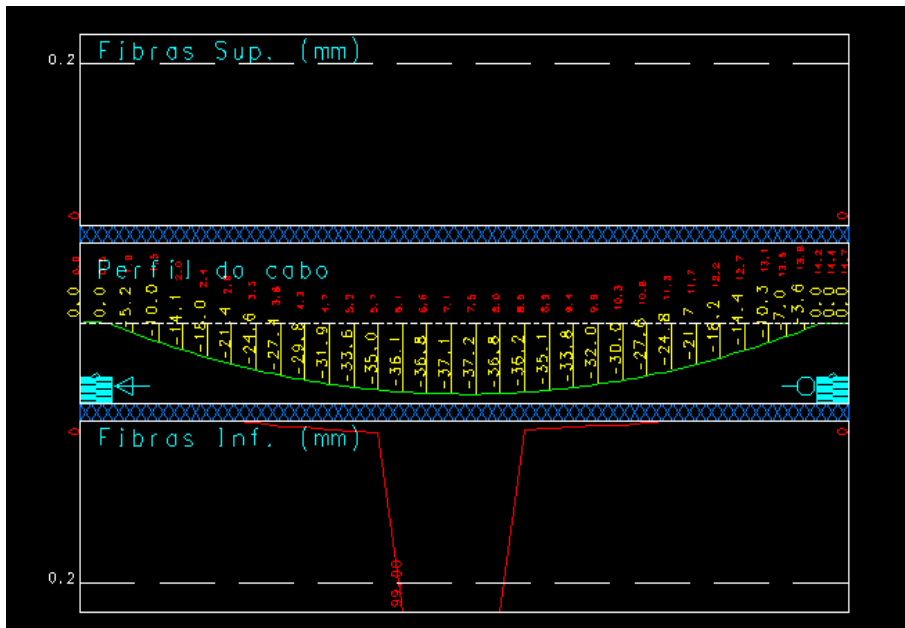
Fissuração viga V11 do 2º pavimento (CAD/TQS)
